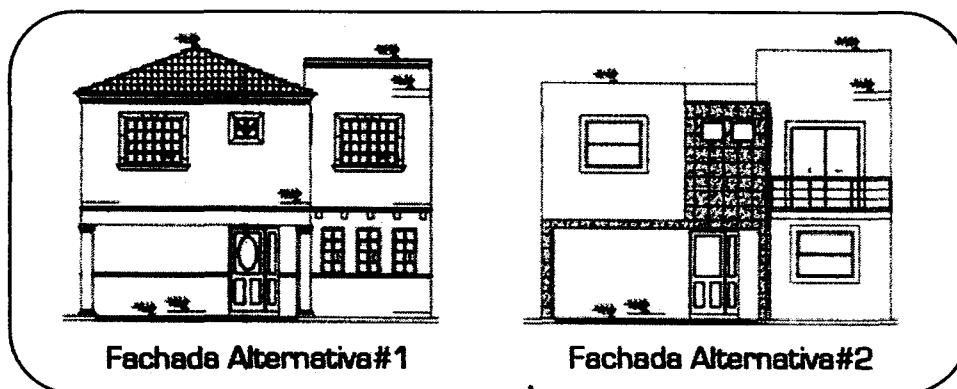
Modificación en Fachada de la Alternativa #2
